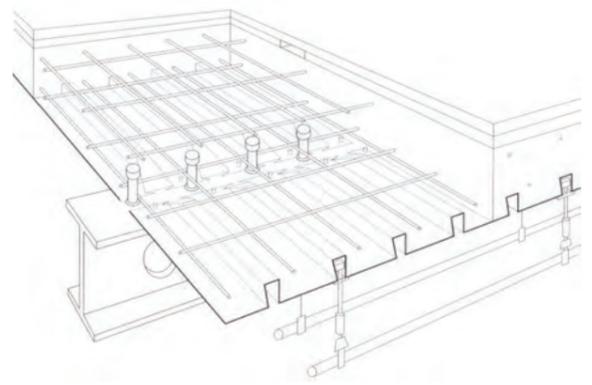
Aufbau Stahl-Stahlbeton-Verbunddecke mit Trapezblech als verlorene Schalung
